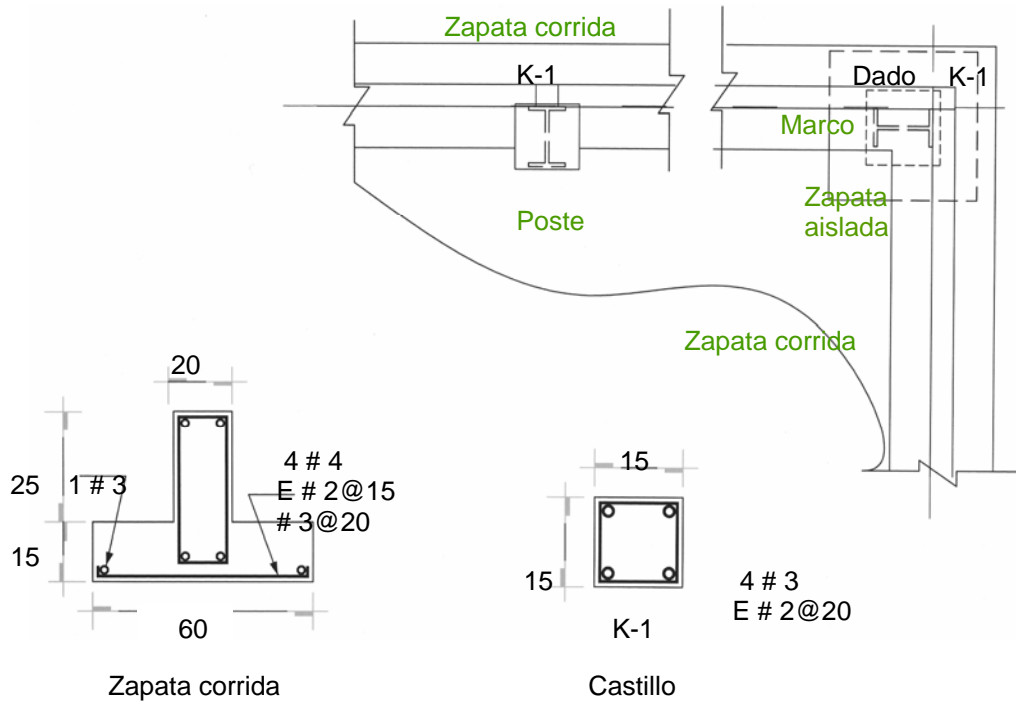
Detalles del diseño de la cimentación, zapatas corridas y castillo para muro perimetral
